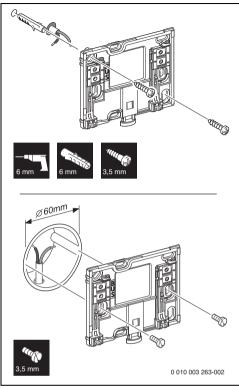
Montaggio della basetta di supporto per installazione a parete
